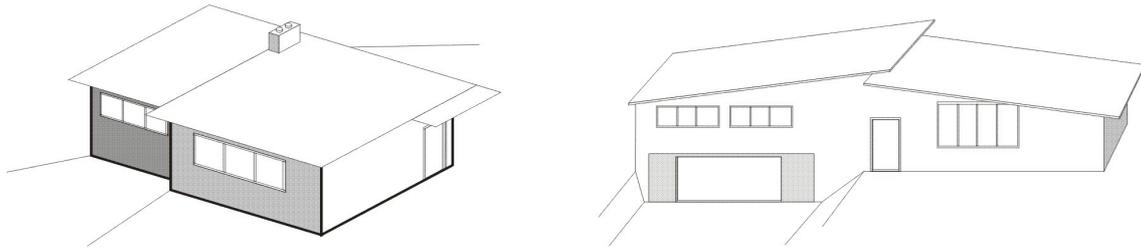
Dois tipos de telhados planos ou Flat: Flat roof (esquerda) e Low-pitched roof (esquerda).
